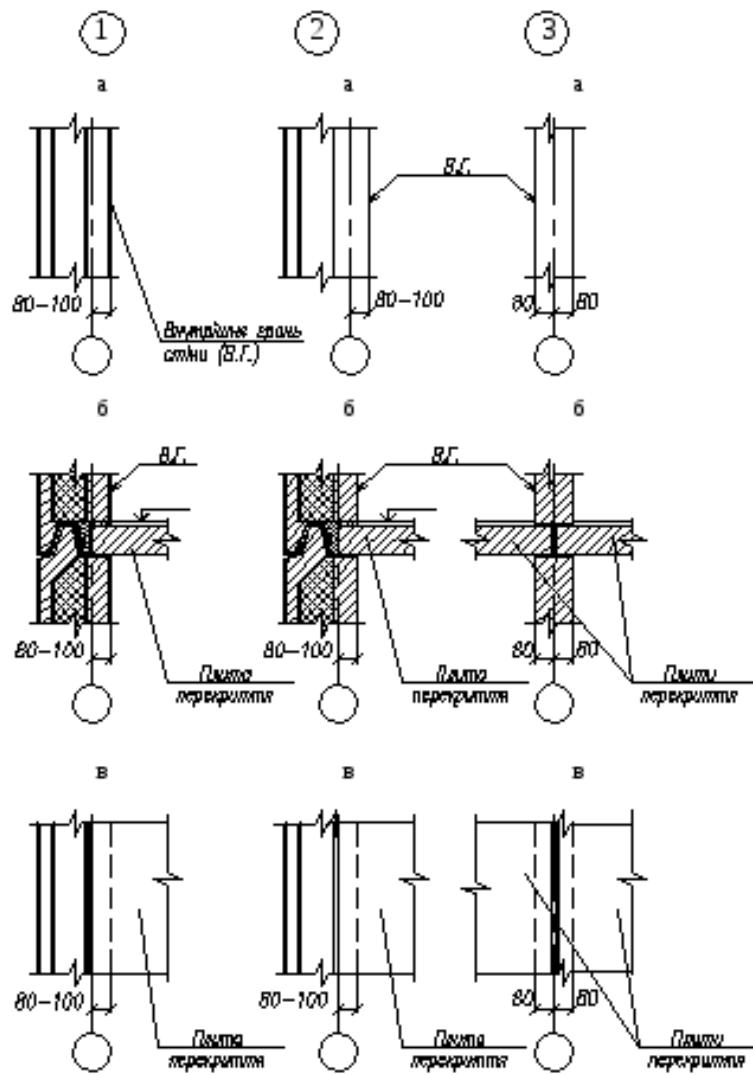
Прив'язки основних будівельних конструкцій крупнопанельних будинків до координатних осей; 1 – зовнішні поздовжні несучі стіни; 2 – зовнішні поперечні несучі стіни; 3 – внутрішні несучі стіни; а – у плані поверхів; б – у розрізі; в – у плані перекриттів з плитами перекриттів
